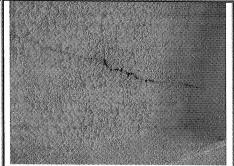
Agrietamiento acompañado de filiación de aguas lluvias en la placa de cubierta del edificio (E-4), Apartamento 502.
